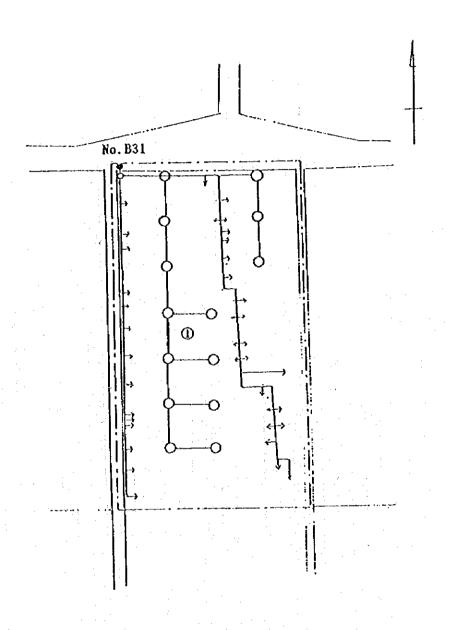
Plan horizontal du projet des installations terminales (Kasuba)
